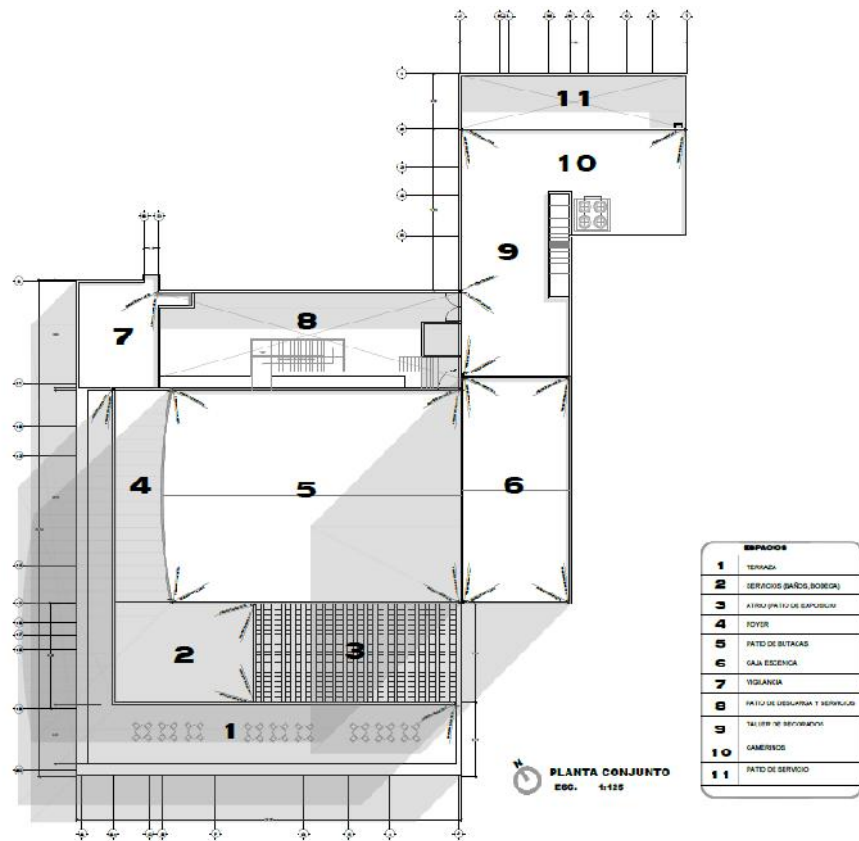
Plano de conjunto. (Fuente: Propia).
